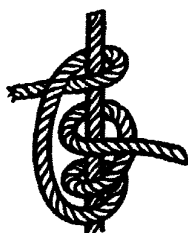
| Enganches para sujetar las vigas de aguja
